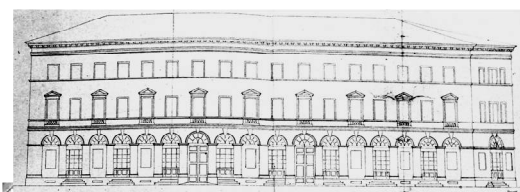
Будинок Папудова, 1832–1833рр., 1843–1846 рр. арх. І.С. Козлов, арх. Ф.І. Моранді, Креслення фасадів та схеми генерального плану [8;9], фото перспективи [4]
